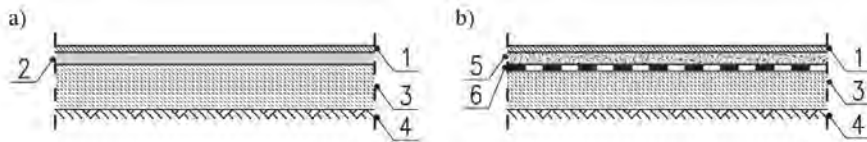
Posadzka z lastryko. Rozmieszczenie i zamocowanie wkładek: a) widok izometryczny, b) przekrój poprzeczny, 1 – lastryko, 2 – wkładki, 3 – podkład cementowy, 4 – podłoże betonowe, 5 – papa, 6 – piasek
